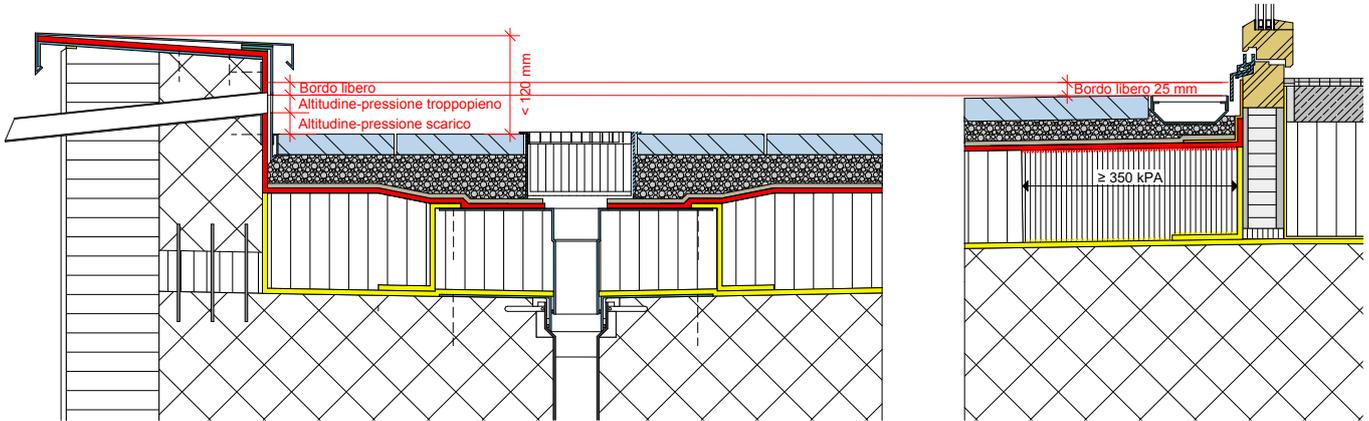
Esecuzione con protezione antitrabocco e troppopieno
